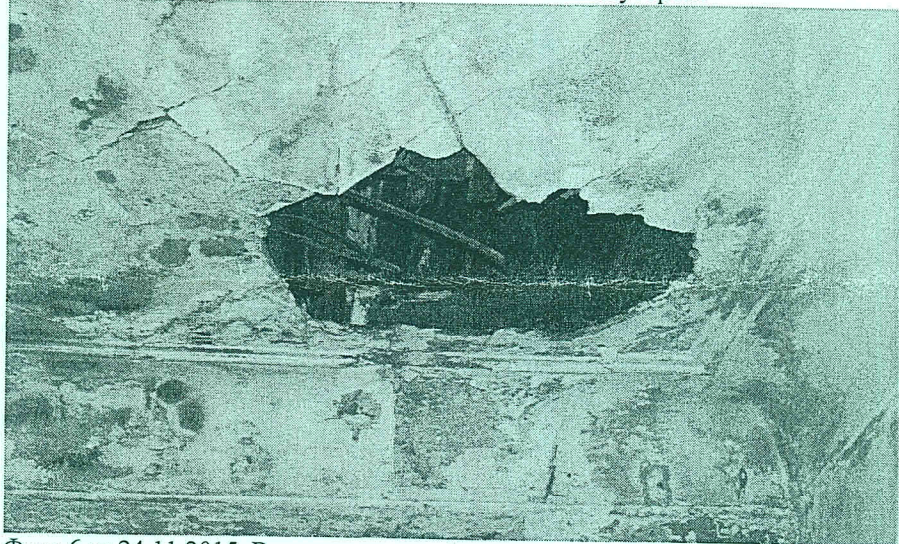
от 24.11.2015. В помещениях зафиксированы разрушения перекрытий и декоративных элементов: следы намокания, отпадение большими массивами штукатурного слоя до оголения дроби, поражение деревянных конструкций перекрытий гнилью, нарушение целостности конструкции перекрытий, сквозные отверстия (обрушения перекрытий).
